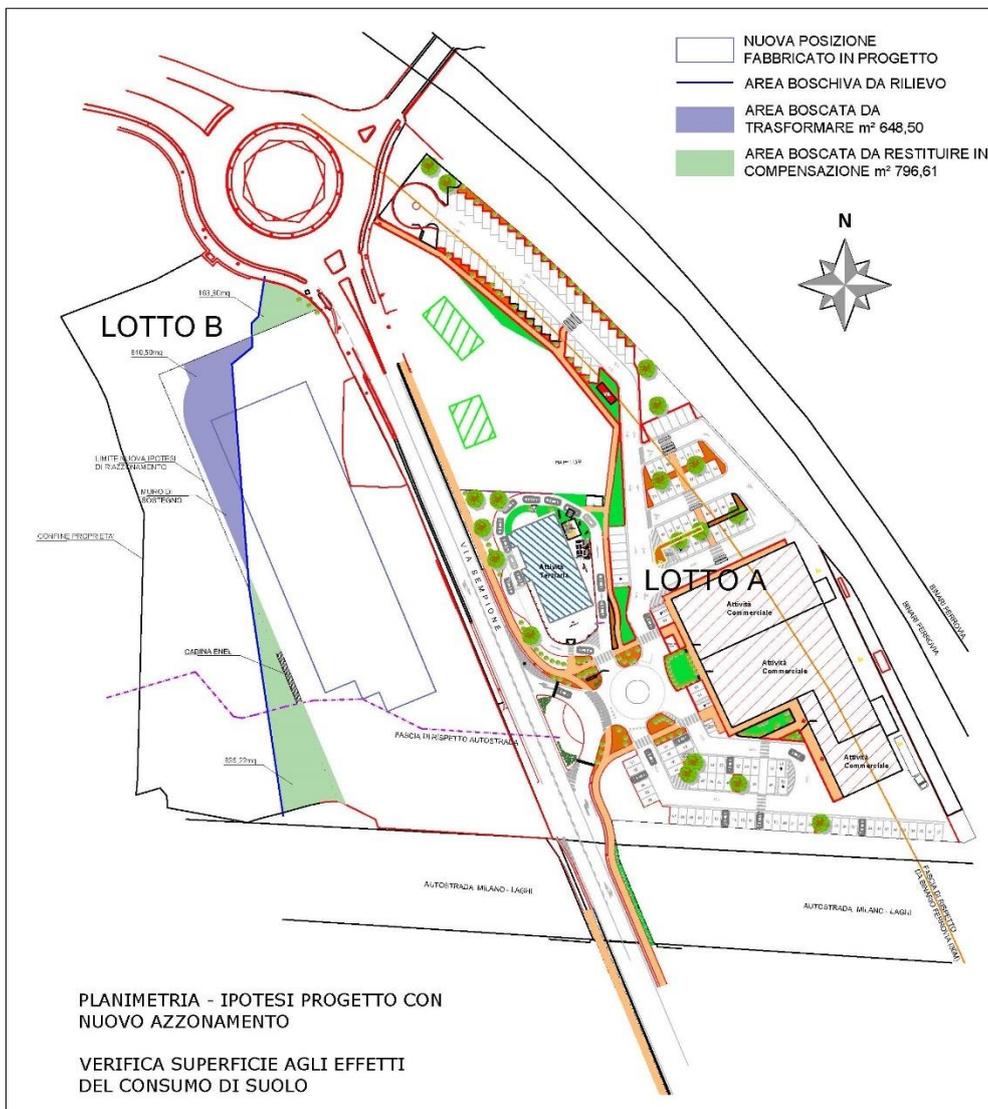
Estratto planimetrico degli elementi di interesse in corrispondenza dell'ambito AR5 secondo la proposta in variante al PGT
